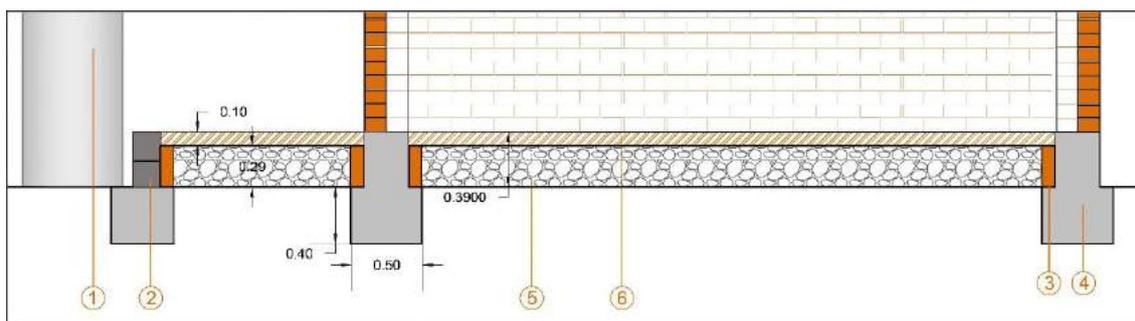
Detalle de la cimentación. Fuente: Elaboración propia
